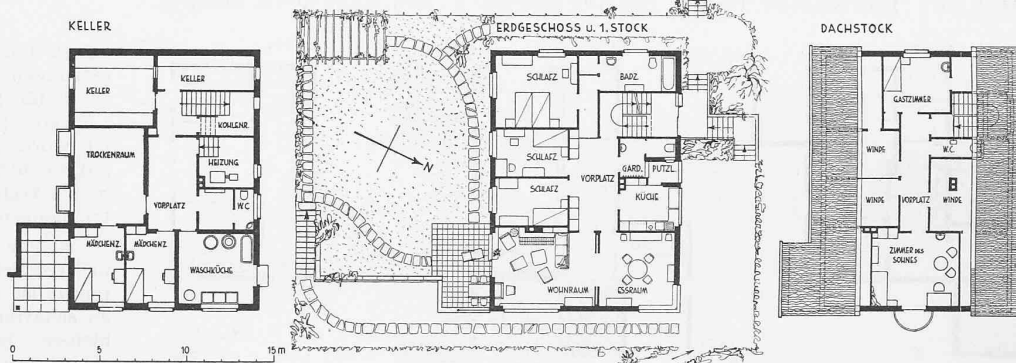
Grundrisse zu Abb. 14 und 15, Masstab 1 : 400. Zu beachten: Diese Zeichnung ist umgekehrt orientiert wie jene aller übrigen Häuser.
